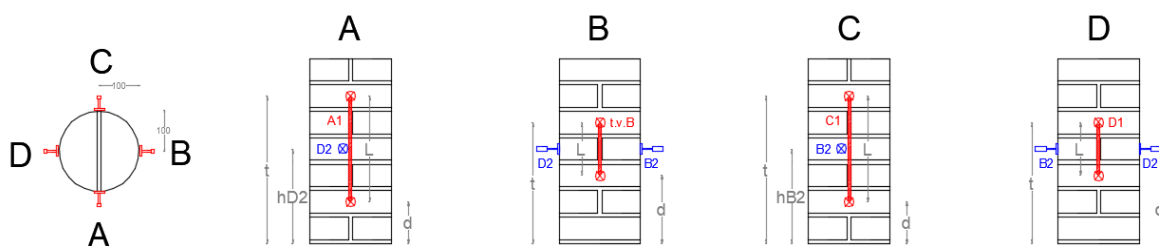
Posizionamento dei trasduttori in pianta e prospetto e dei punti di misura.
